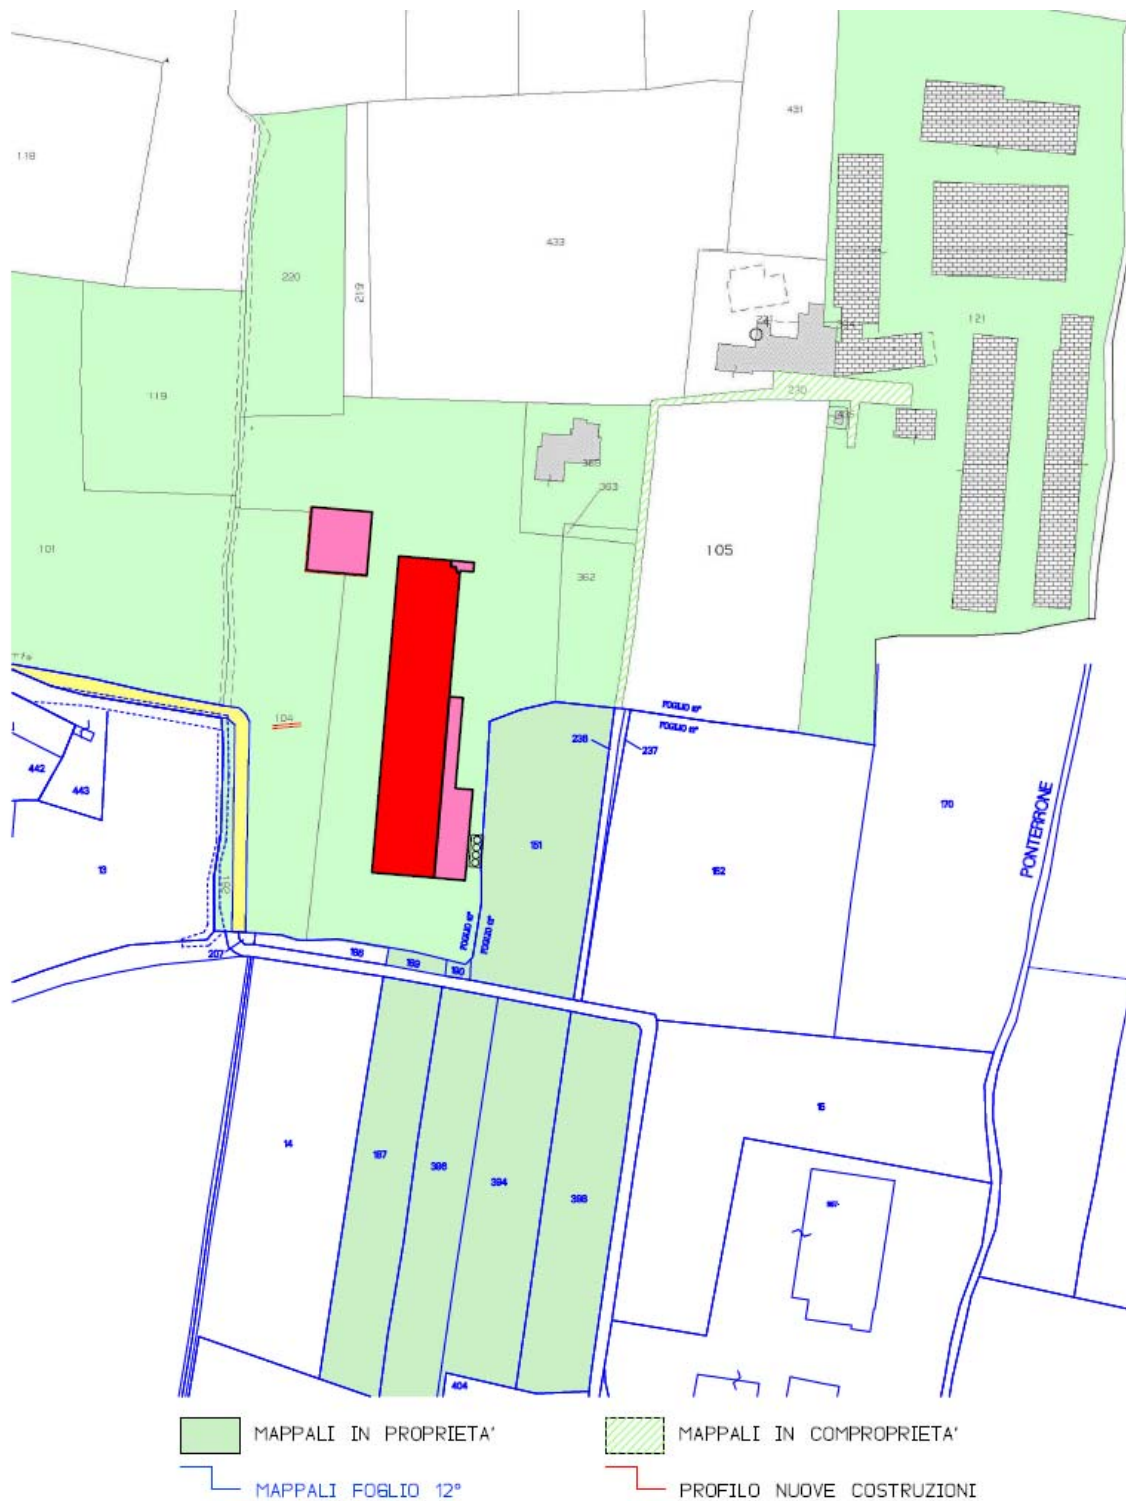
stralcio estratto di mappa scala 1:2000 con inserimento piante interventi in progetto
